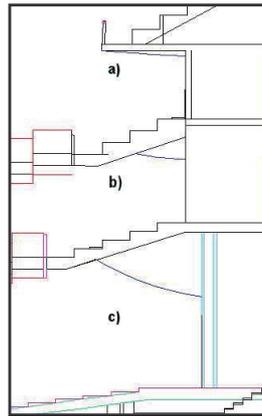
Cielos rasos reflectantes bajo balcones, a) cielo raso bajo tercera galería, b) cielo raso bajo segunda galería y c) cielo raso bajo primera galería.
